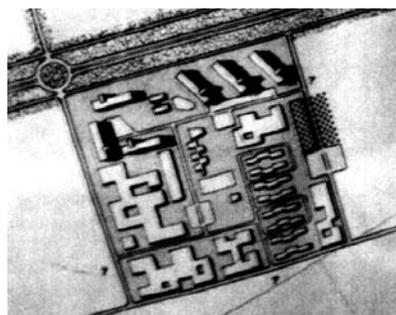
Detalle de la Unidad Vecinal en el Plan Piloto de Cali, 1950
